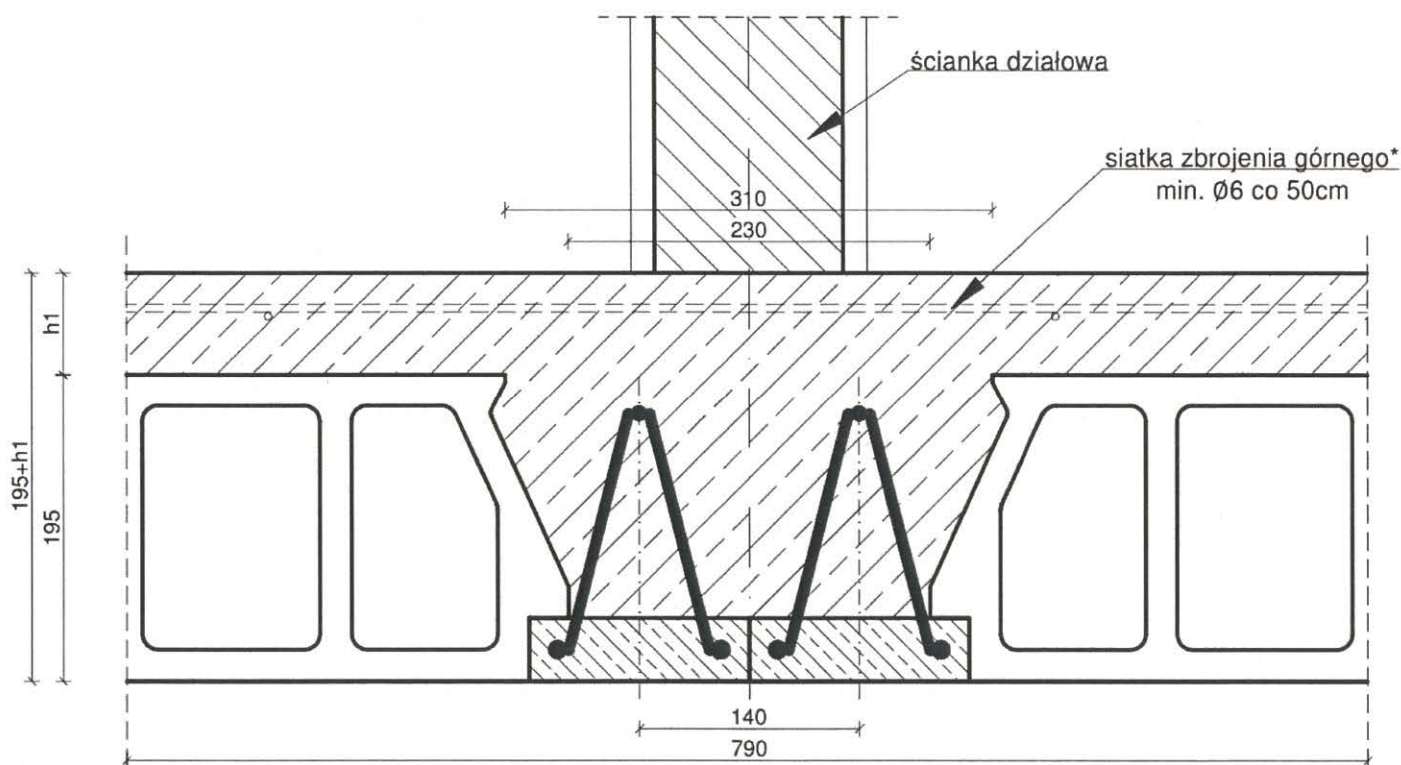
Przykład żebra rozdzielczego z wykorzystaniem elementu szalunkowego LEIER dla żebier rozdzielczych oraz rozwiązania tradycyjnego żebra rozdzielczego.
